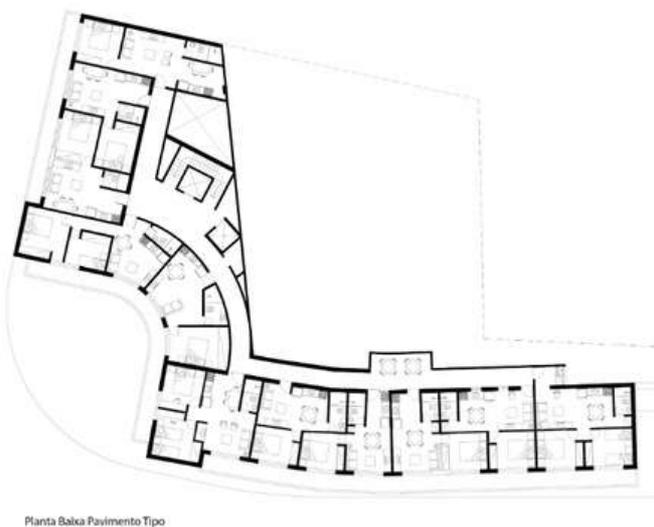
Planta da Baixa com Layout Proposta do Pav. Tipo
